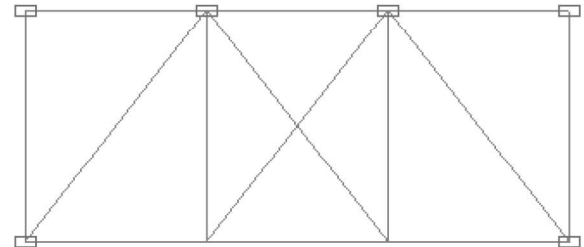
Расчетная схема нижнего пояса для расчета по методу № 4
